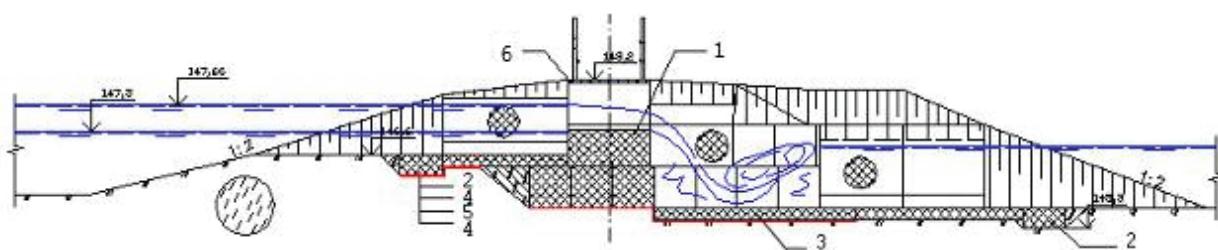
Водосбросная плотина из габионов: 1 – бетонировка или покрытие из камня на растворе 0,15 м; 2 – габионы 2x1x0,5 м; 3 – матрасы Рено 3x2x0,23 м; 4 – геотекстиль; 5 – полиэтиленовая плёнка; 6 – плиты перекрытия
